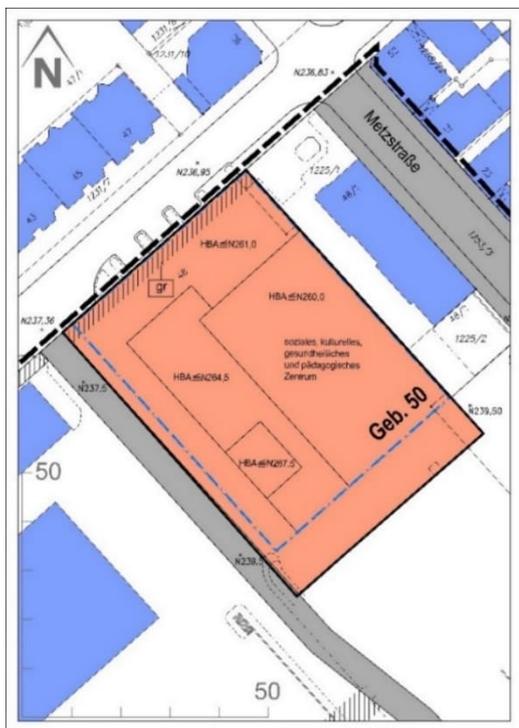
Ausschnitt Rahmenplan Der neue Stöckach
